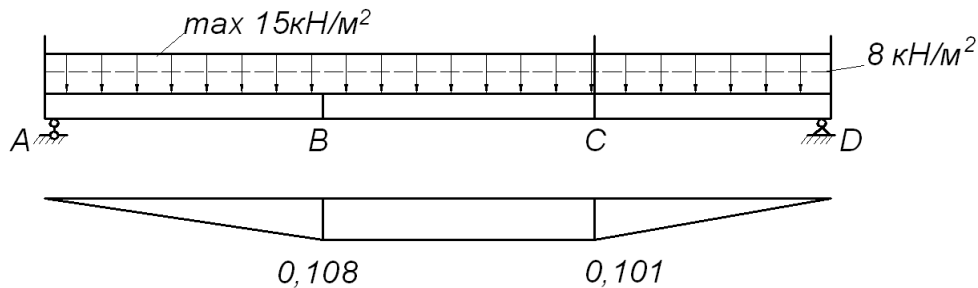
Характер деформирования фрагмента перекрытия при нагружении по схеме 3
